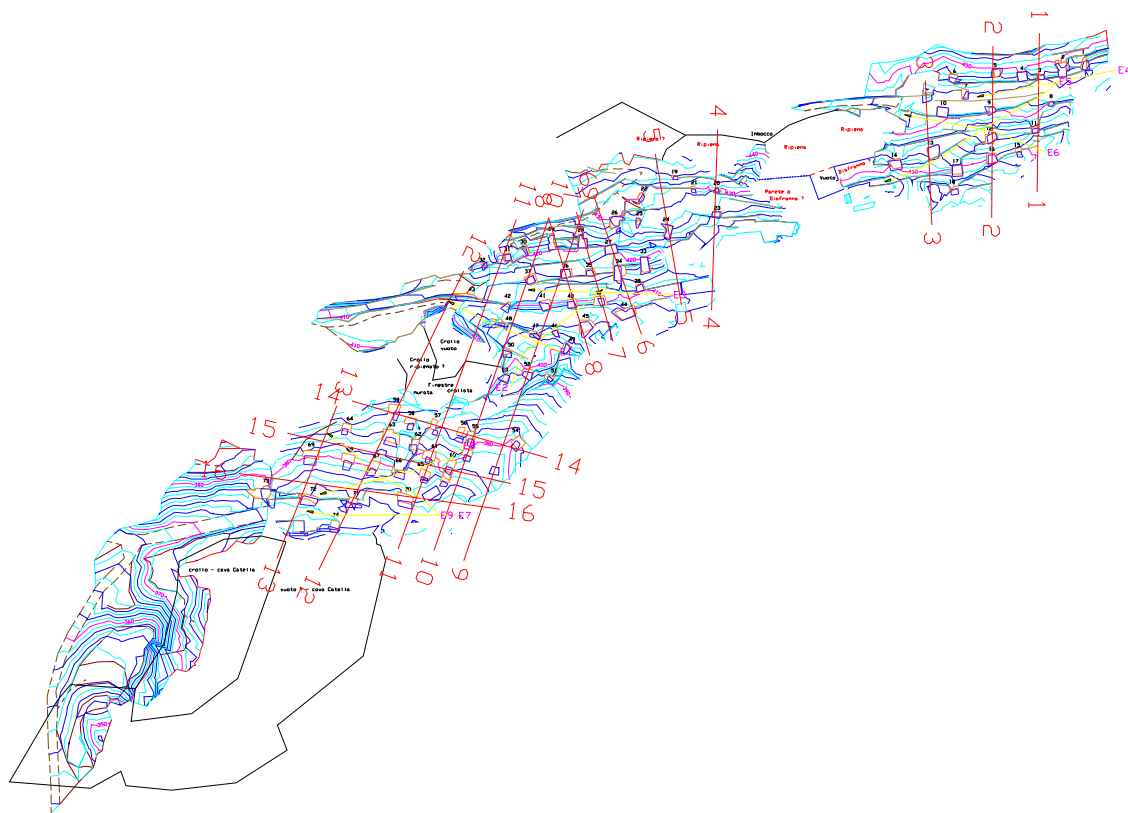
Planimetria della cava con indicazione delle sezioni di analisi
